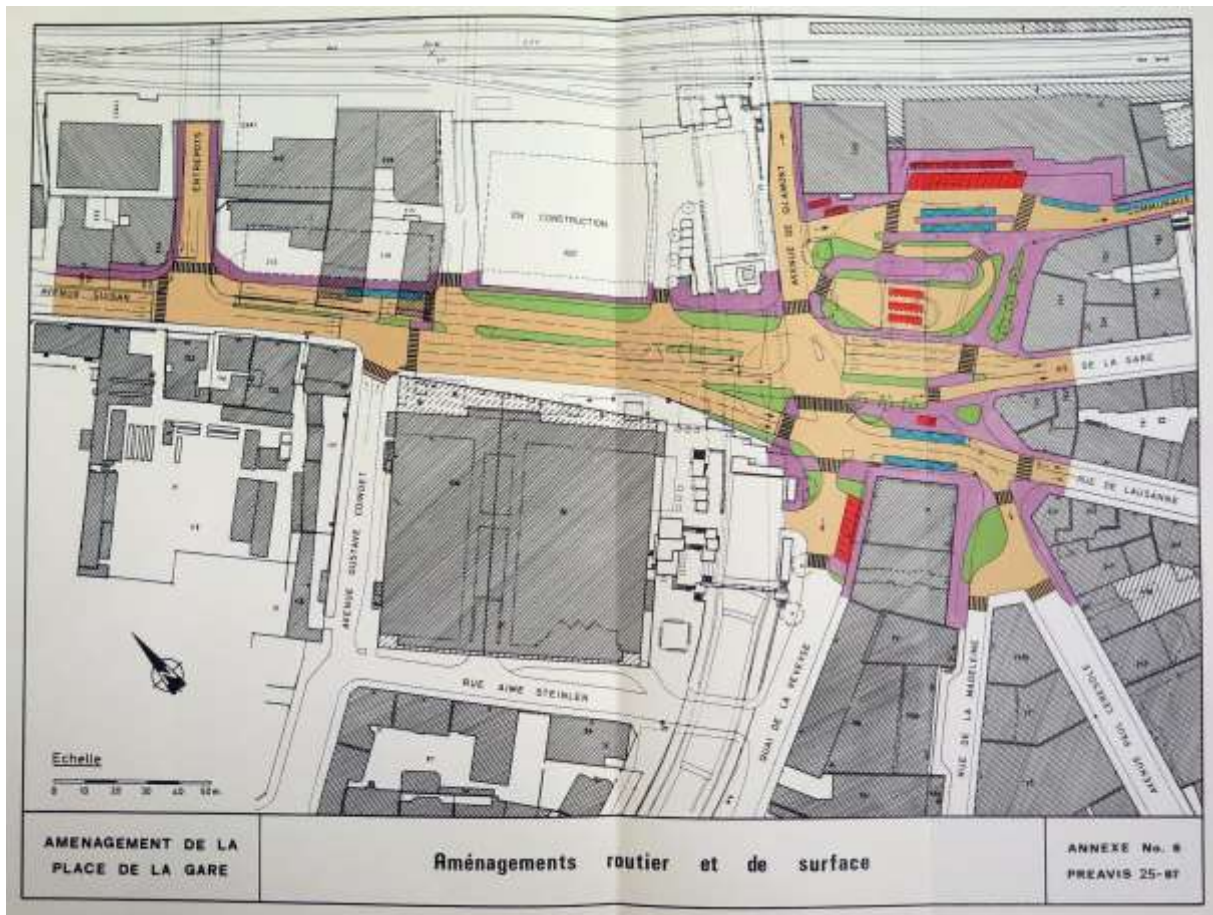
Aménagement de la place de la Gare, plan, 1987 (Préavis du Conseil municipal sur l'aménagement de la place de la Gare, 12.8.1987).
